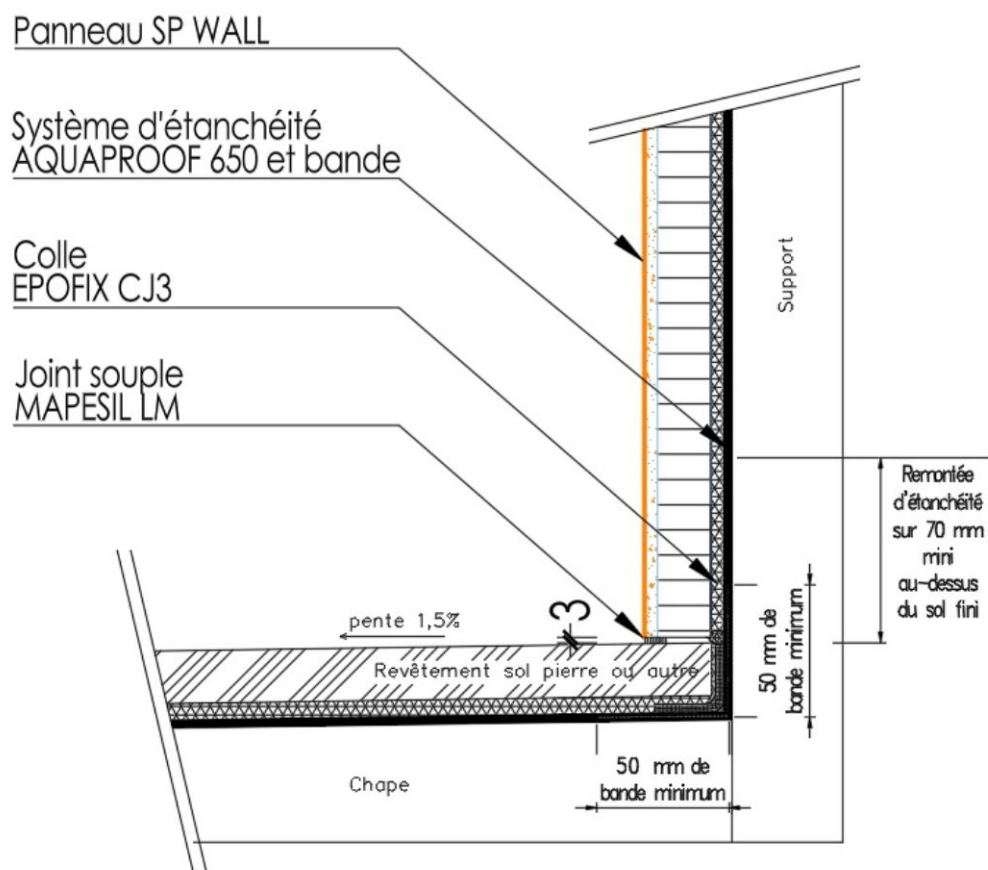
Traitement du raccord dans le cas d'une douche accessible « zéro ressaut »
